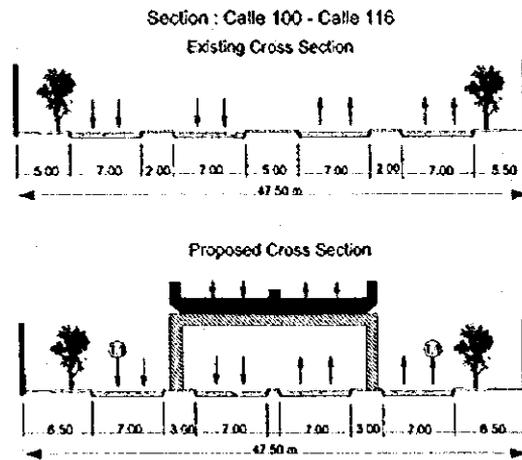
Sección Típica sobre la Avenida 7a (2)
